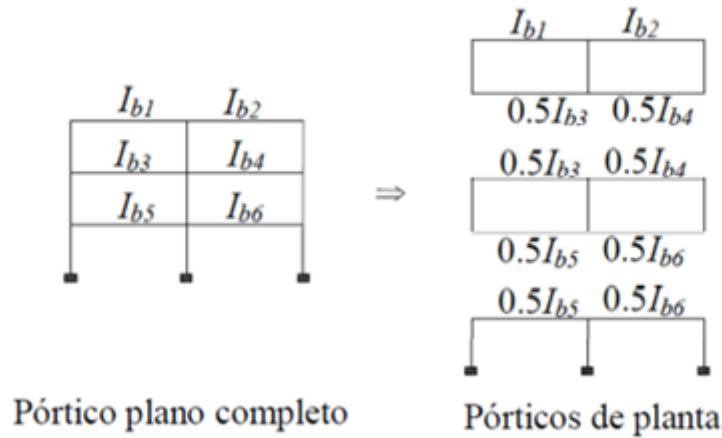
Descomposición pórtico de planta en pórticos ficticios para cálculo de rigidez de pilares con giro en extremos.
